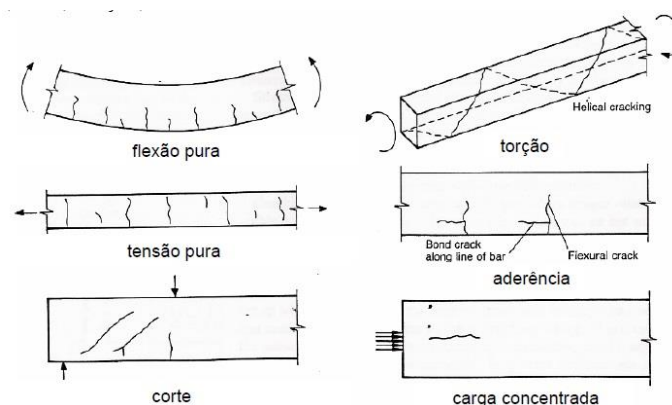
Fissuração resultante da aplicação de cargas actuantes: flexão, corte, tracção, etc
